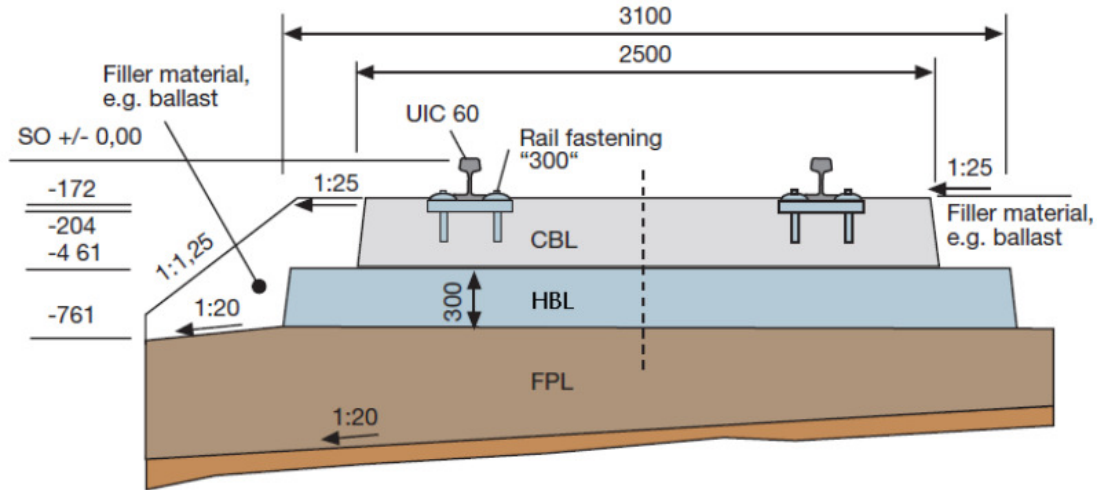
IPA üstyapı plan ve enkesiti [5].
